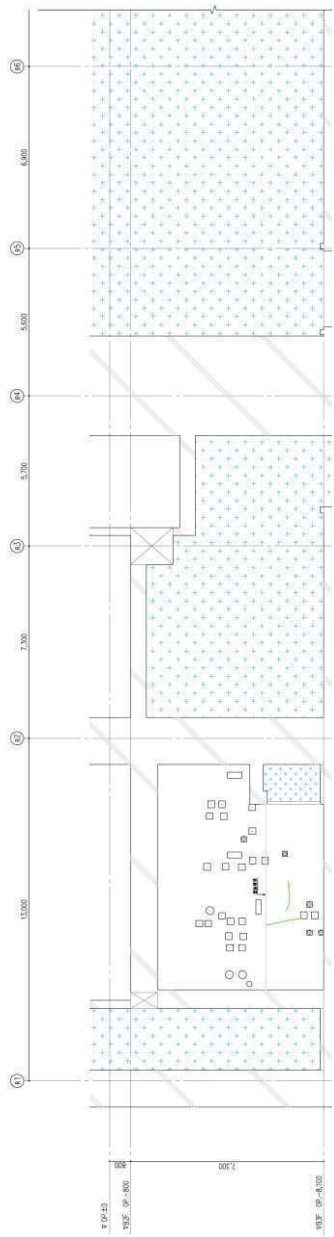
原子炉建屋のひび割れ分布 耐震壁 (4) 地下3階 R11 通り
